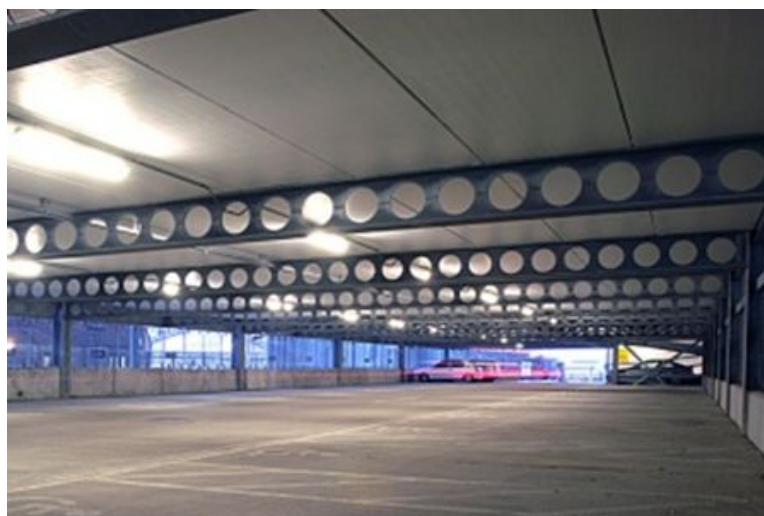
Комбинированное сталежелезобетонное перекрытие гаража
